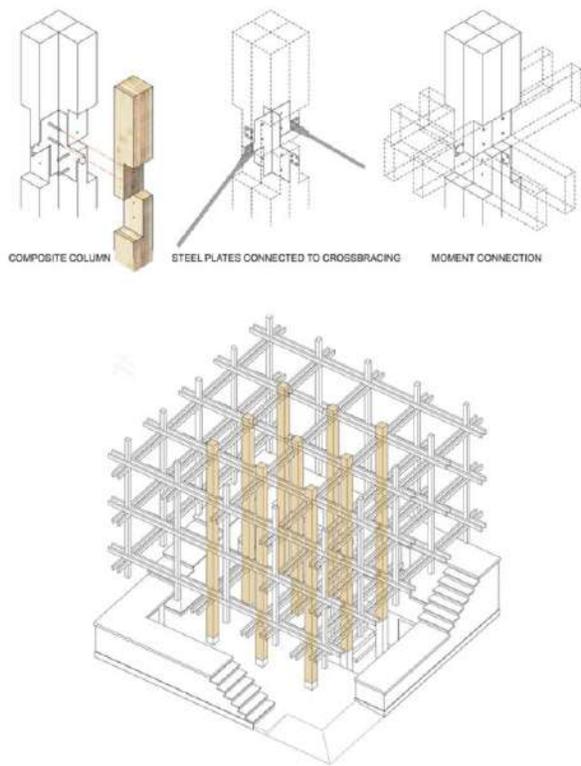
Detalhamento construtivo do encaixe da viga em MLC no pilar em MLC, no projeto Nest We Grow. (fonte: KKAA; crédito: Shinkenchiku Sha)
